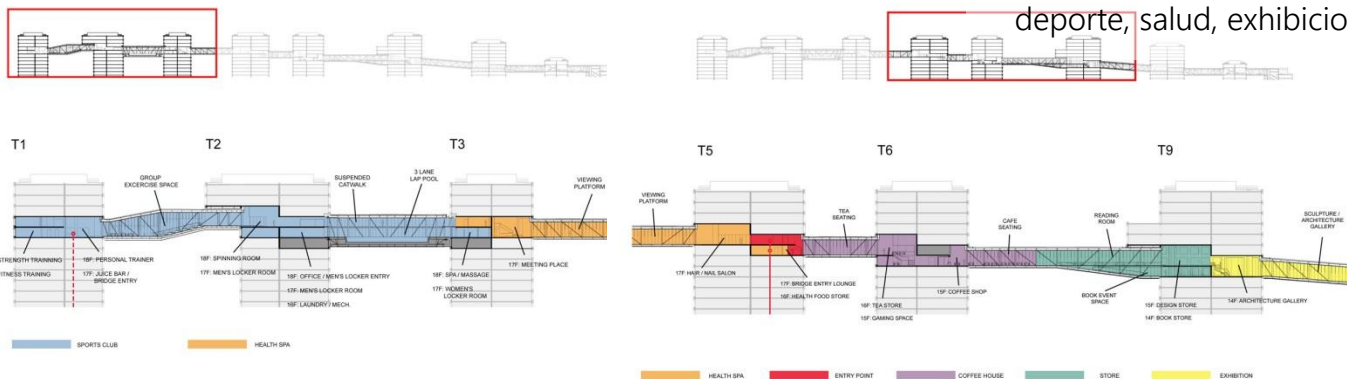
PROYECTO LINKED HYBRID FUENTE <https://www.archdaily.com/34302/linked-hybrid-steven-holl-architects>
